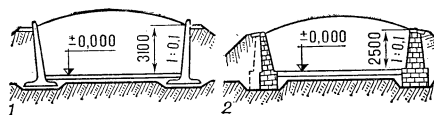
Наземные траншеи: 1 — из железобетонных блоков; 2 — из бутового камня.
